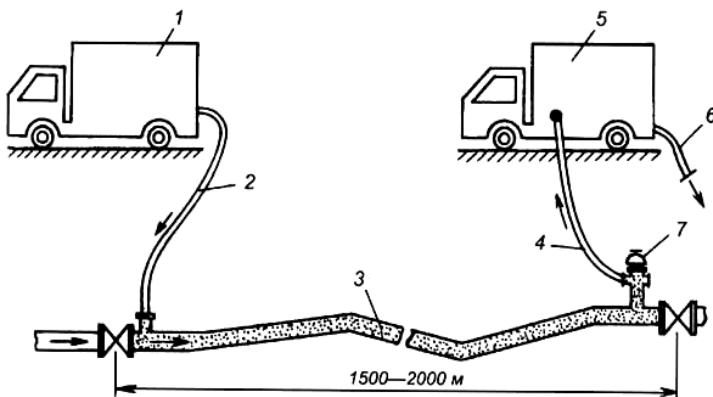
Схема водо-воздушной прочистки трубопроводов:
